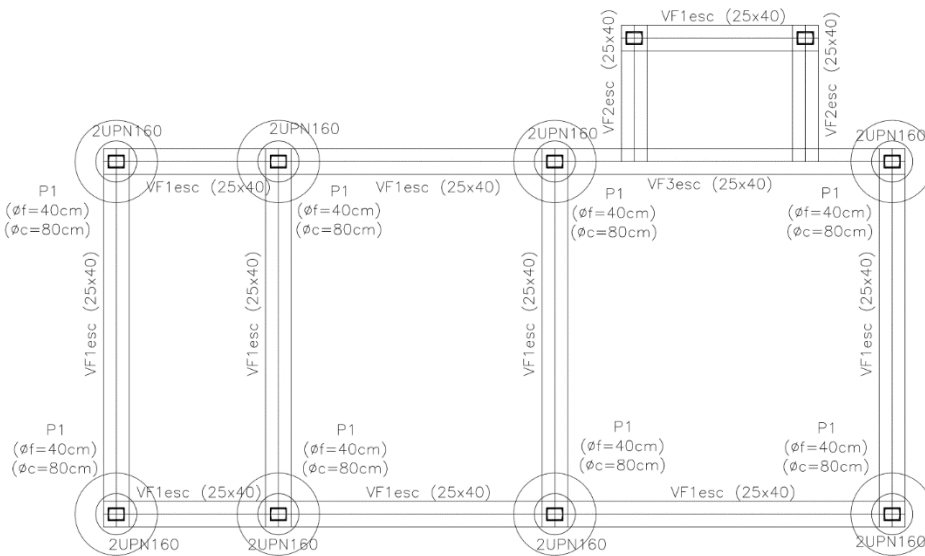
Planta de Fundación escalera metálica sobre Patio Central.
